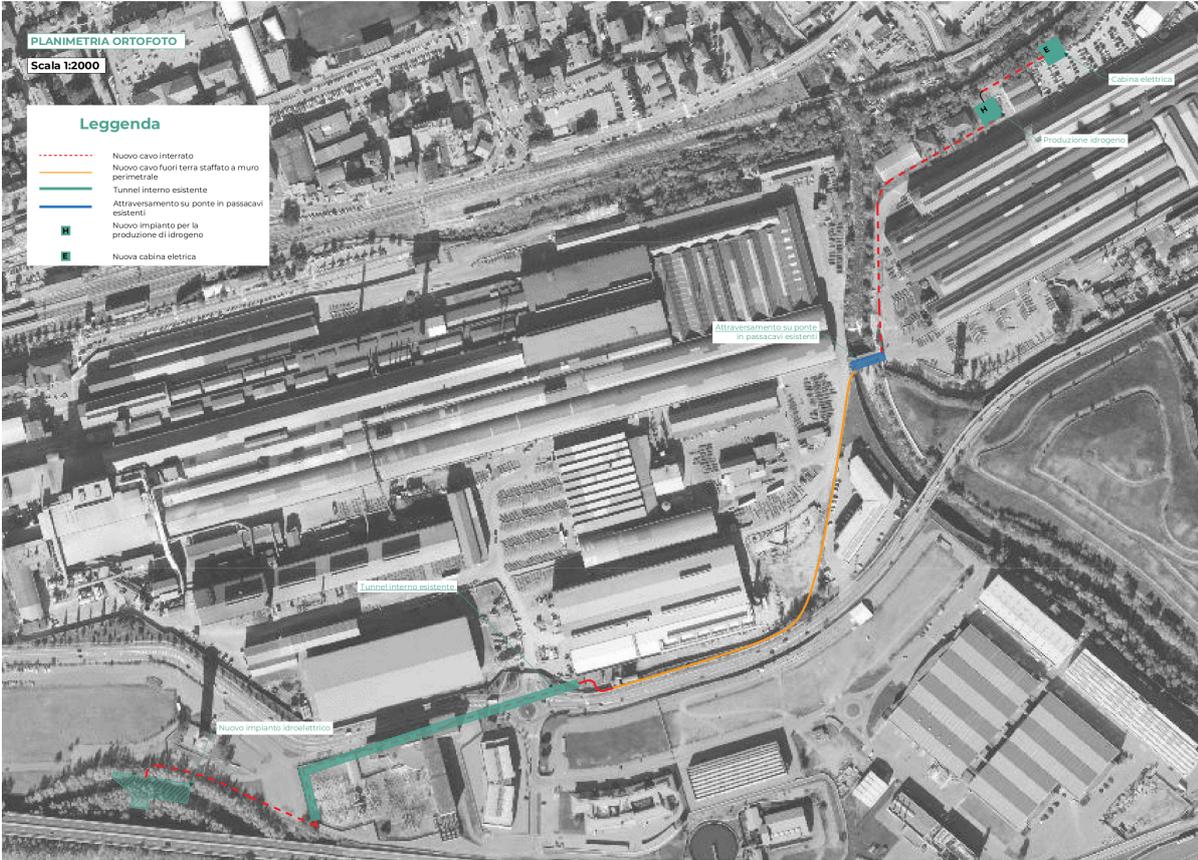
Planimetria tracciato cavidotto di alimentazione dell'elettrolizzatore.
